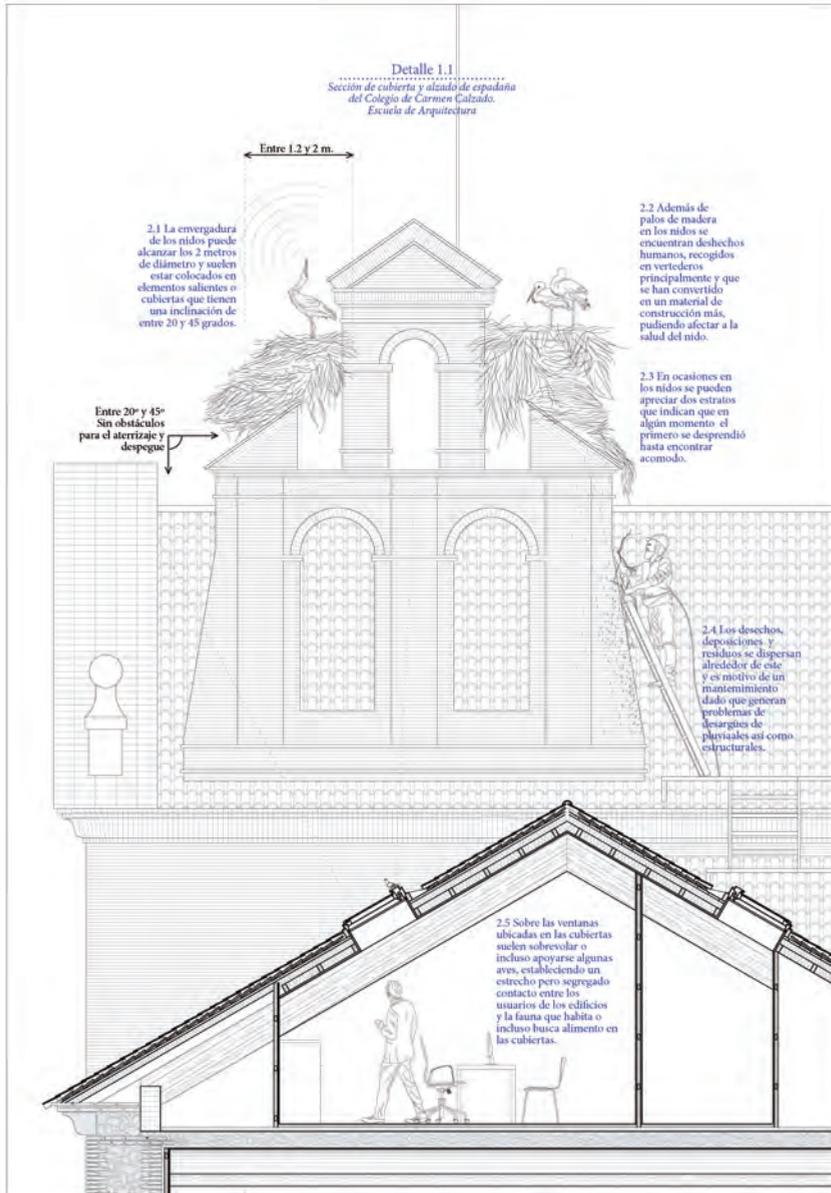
Lámina 2. Sección de cubierta y alzado de espadaña. Elaboración de los autores, 2023.
